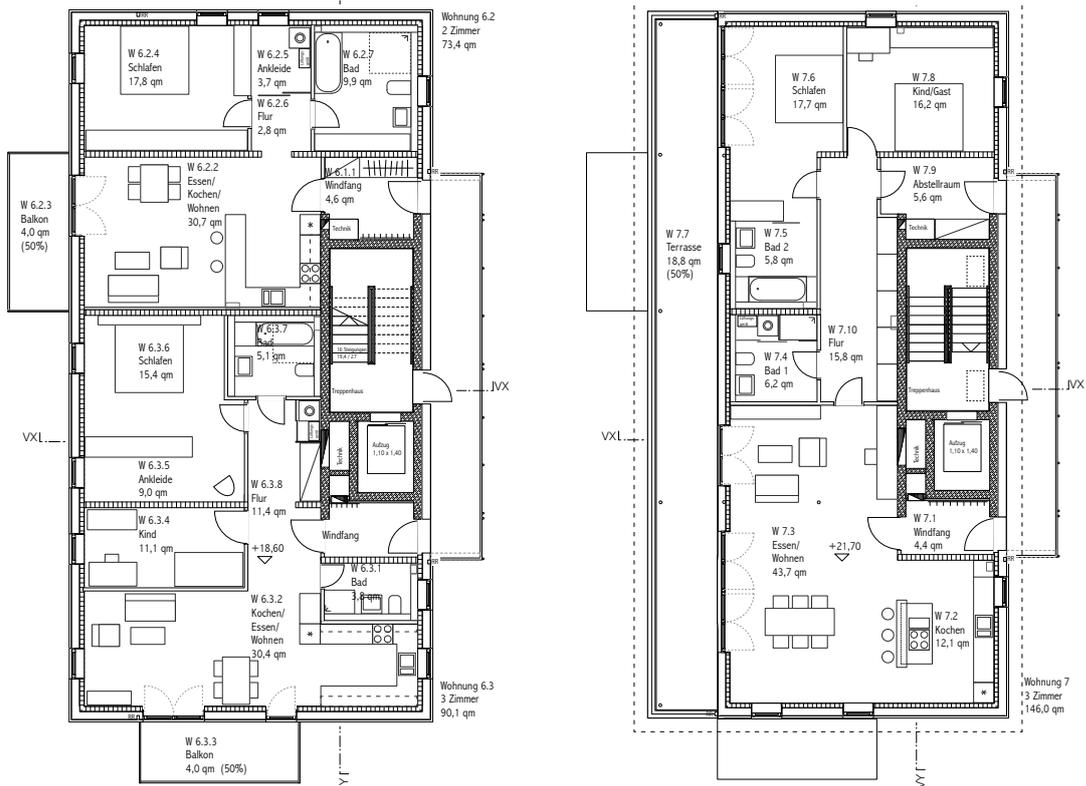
Typengrundriss Wohnung 2-Spänner rollstuhlgerecht / Penthouse
